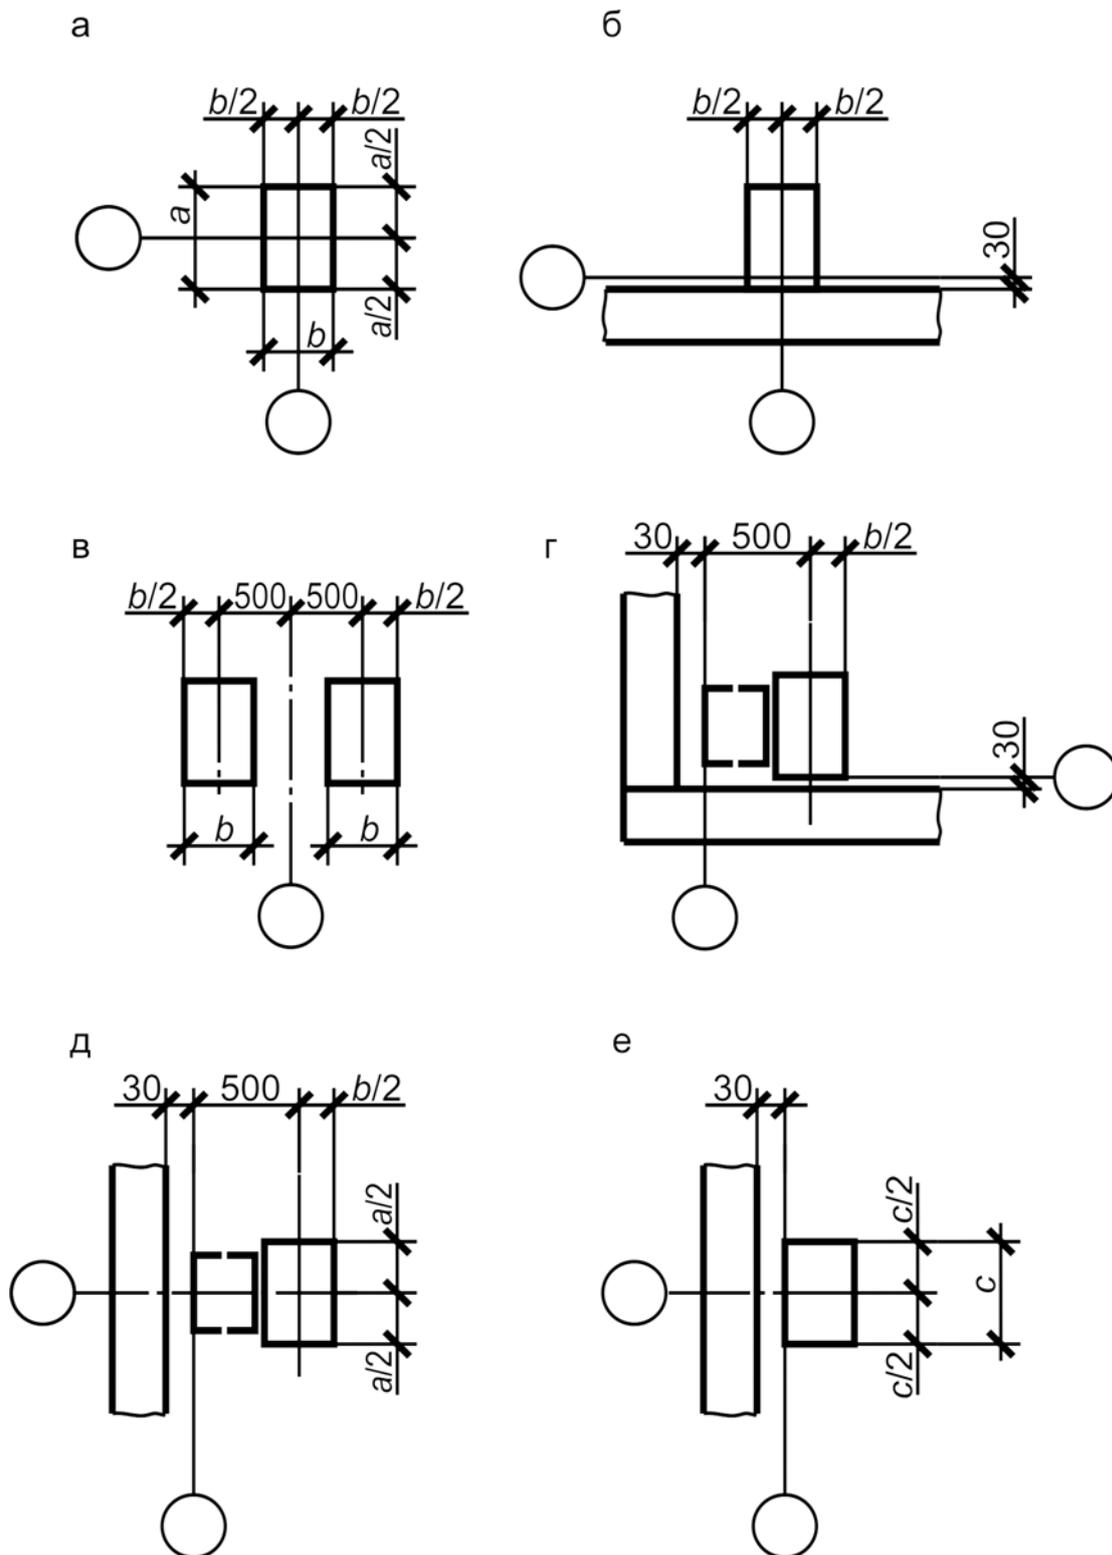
Привязка колонн и стен к продольным и поперечным координационным осям:
